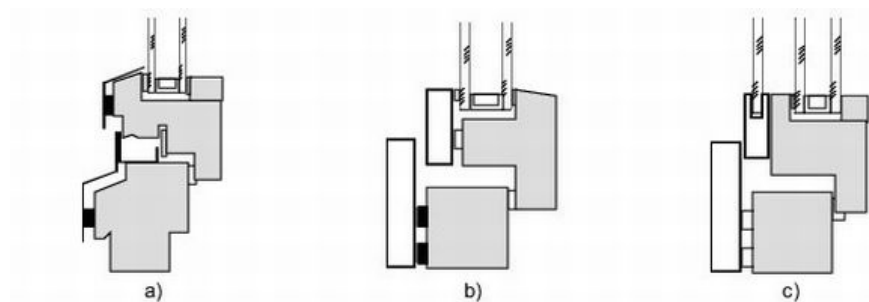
Konstruktionsprinzipien Holz-Metallfenster
